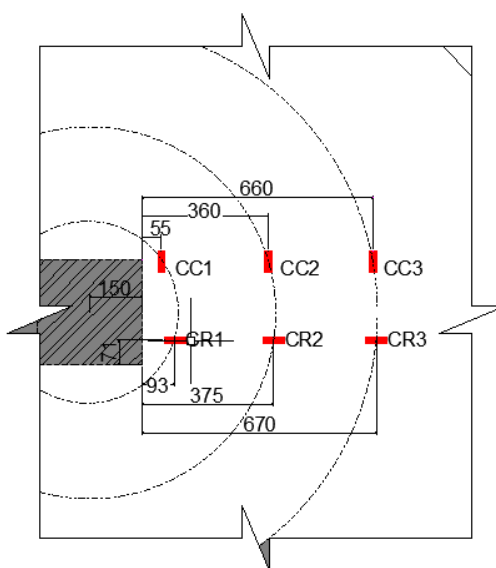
Posicionamento dos extensômetros no concreto (Autora, 2023).
